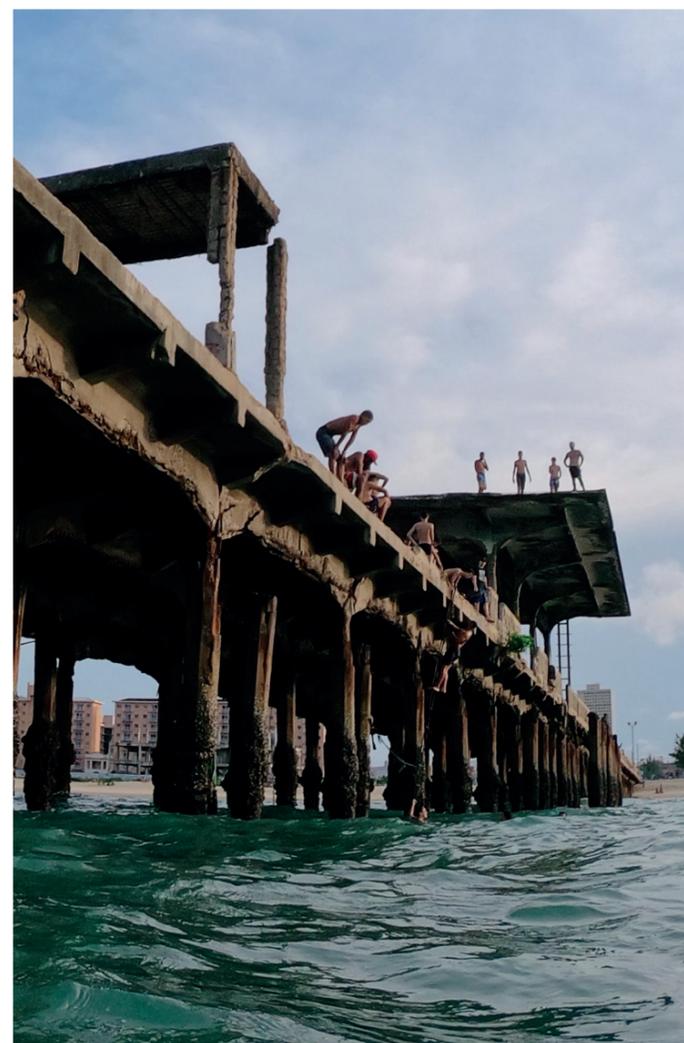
PONTE METÁLICA OU PONTE VELHA
